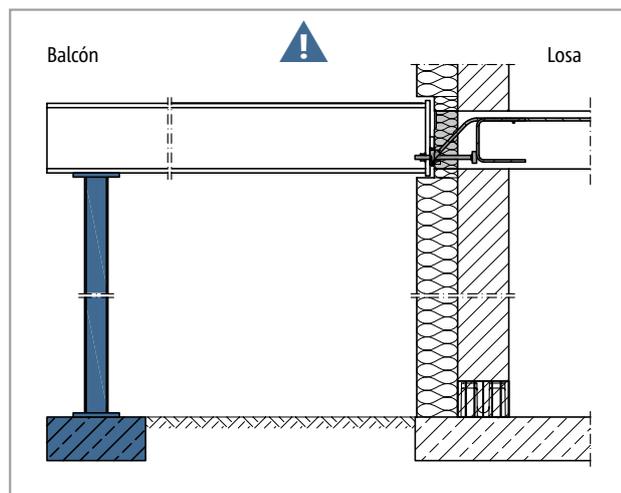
Schöck Isokorb® T tipo SQ: Se requiere apuntalamiento continuo
